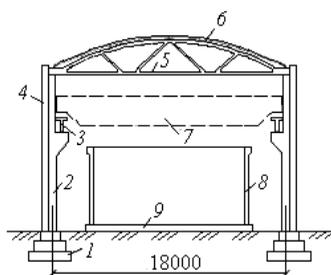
Поперечный разрез здания фильтров: 1 – фундамент; 2 – колонна крайнего ряда; 3 – подкрановая балка; 4 – стеновые панели; 5 – стропильная ферма; 6 – плита покрытия; 7 – мостовой кран; 8 – стеновые панели фильтра; 9 – днище фильтра
